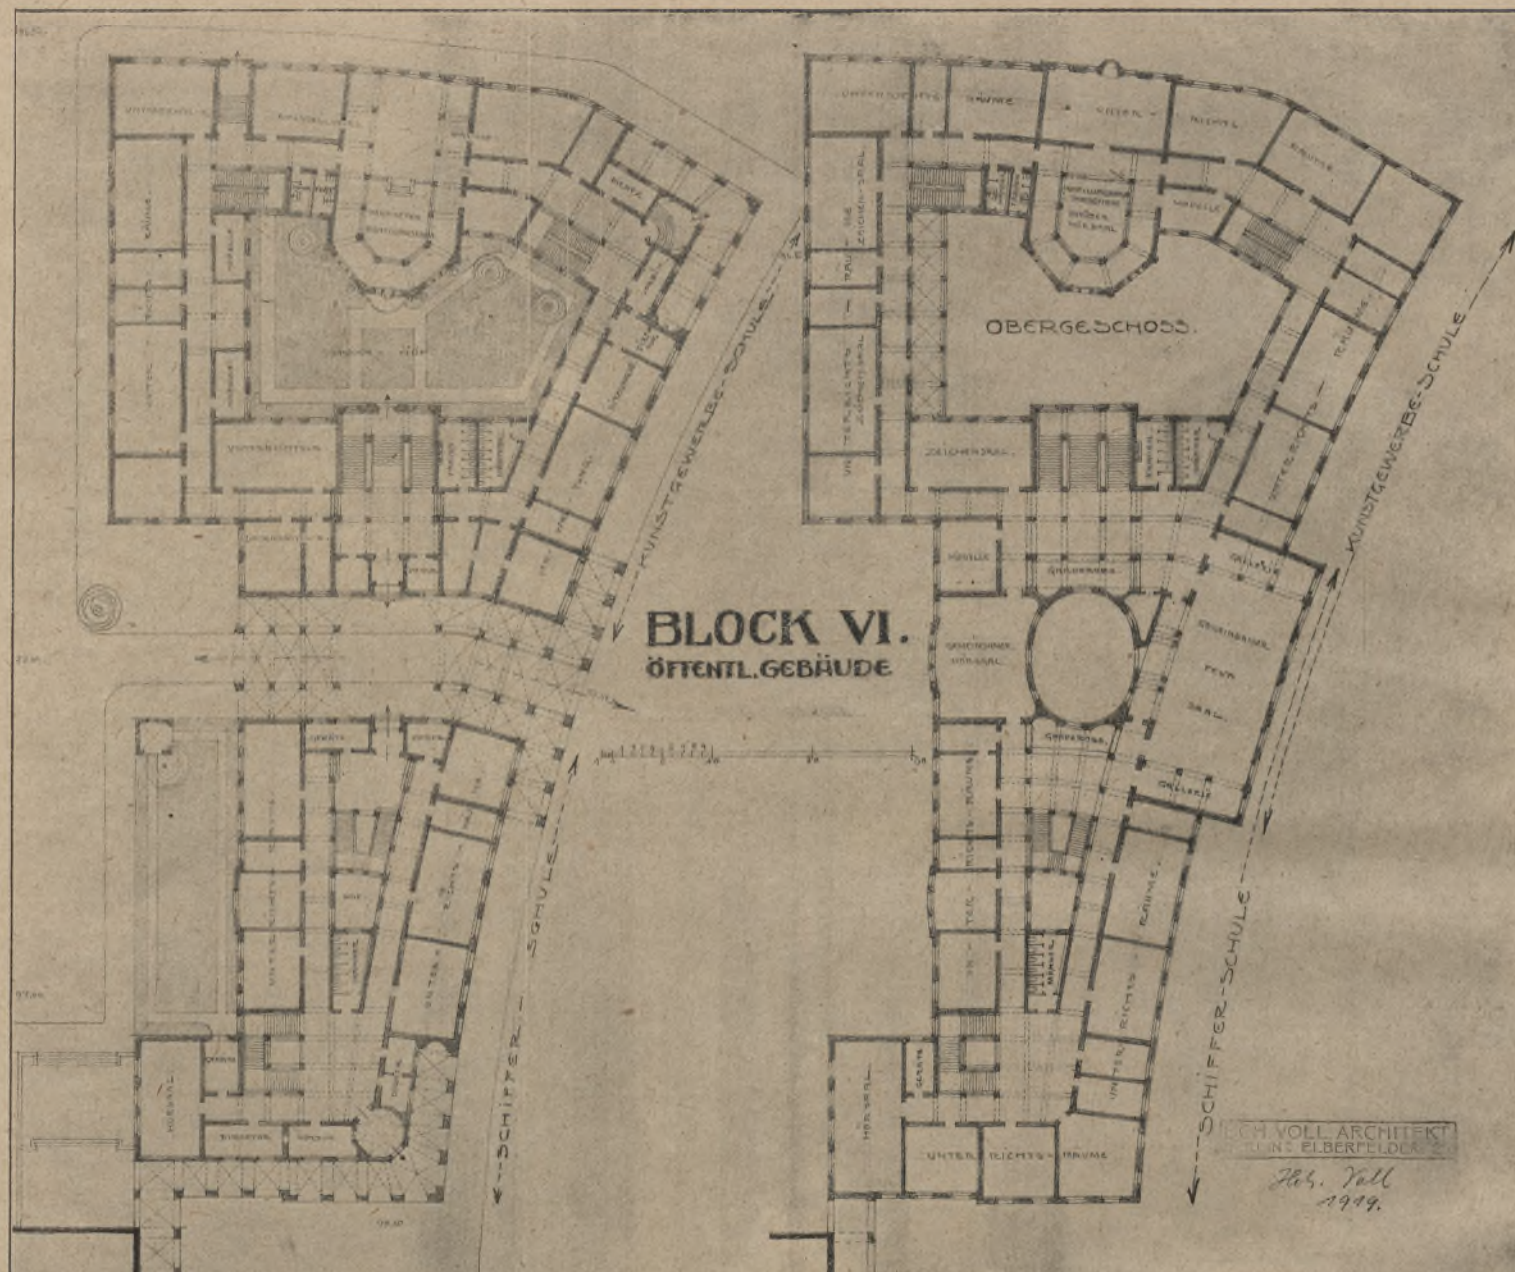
Mannheim. Bebauungsplan für das Baugebiet Schafweide und Altwasser. Grundrisse Block VI: Öffentliche Gebäude. Maßstab 1:750.
